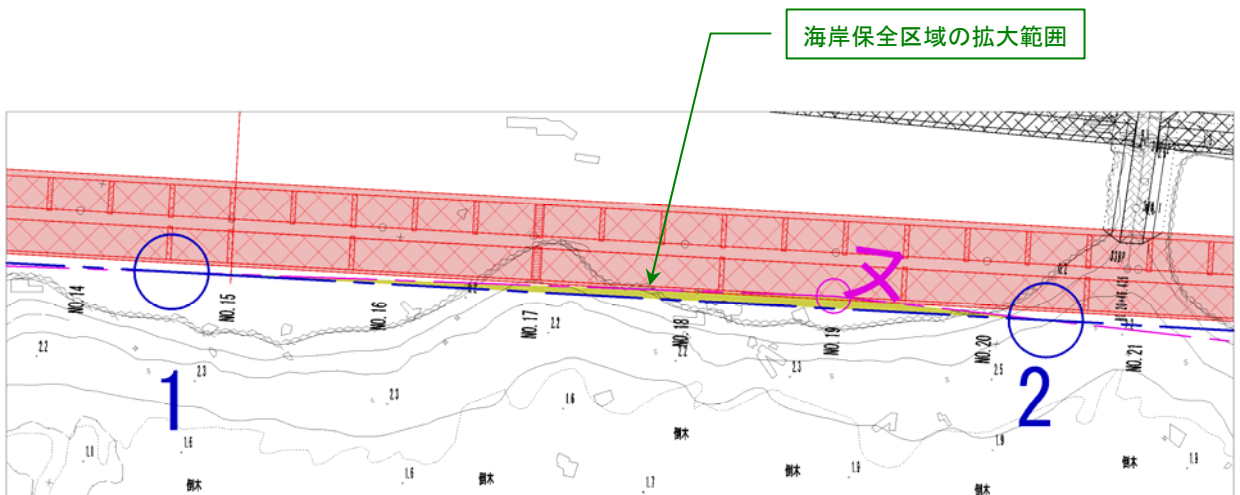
海岸保全区域の拡大区間平面図(No.15~No.20)
